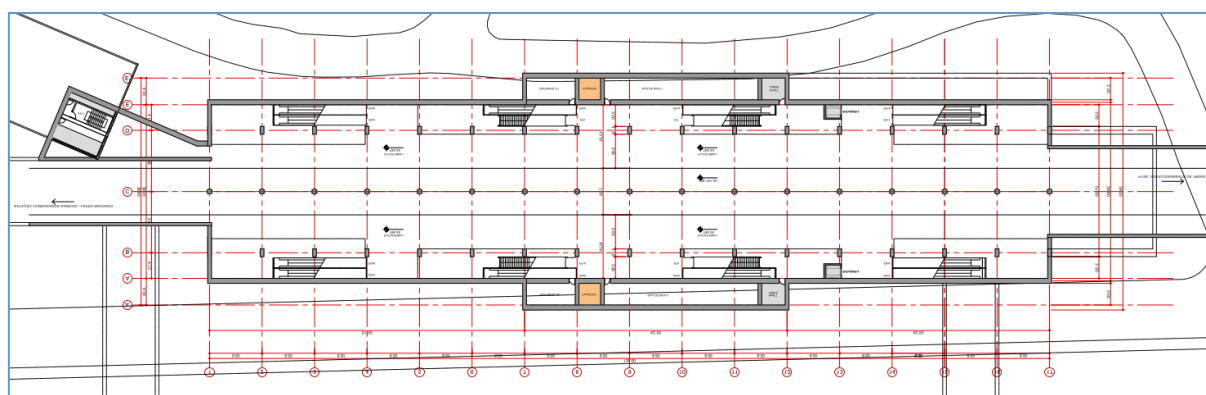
Planta do nível da plataforma - Estação Jardim Ângela
